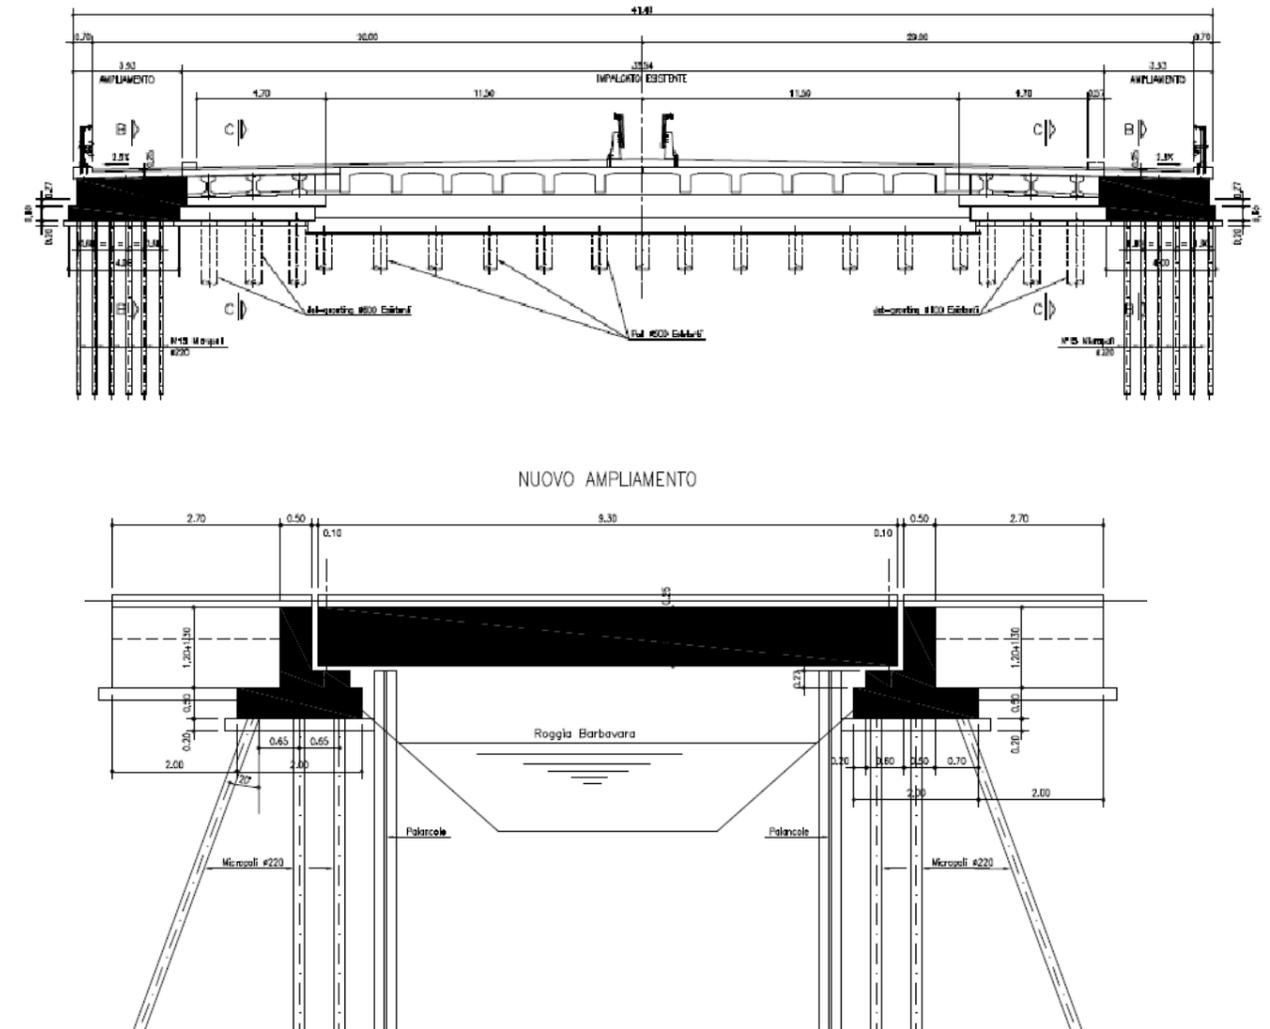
Roggia Barbavara - Sezione trasversale e longitudinale
